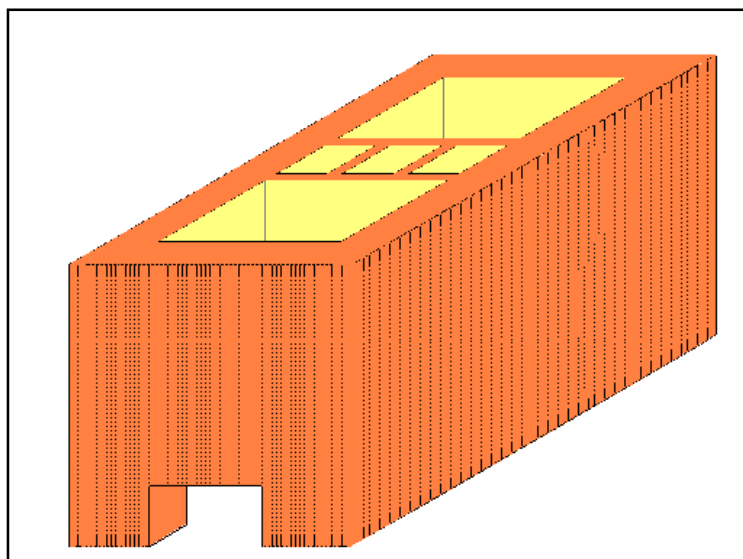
Bloco cortado para passagem de eletroduto horizontal.
